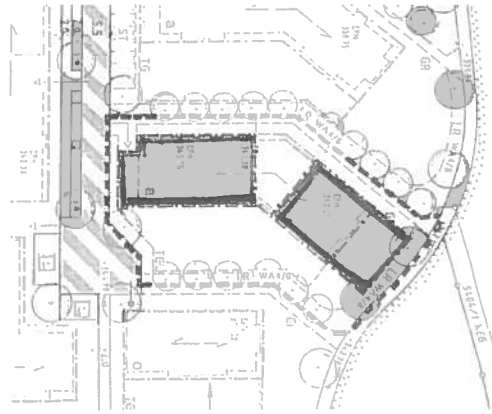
Bebauungsplan „Ziegelei“, „Ziegelei, 1. Änderung
